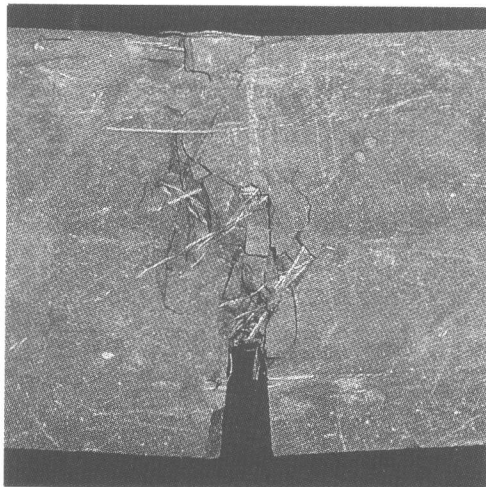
スチールコード混入FRCCの切り欠き先端のひび割れ状況
